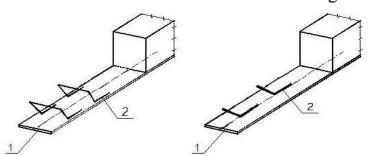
Die biegsamen Stahlbetonelemente mit der äußerlichen Blattbewehrung: 1 – das Stahlstützblatt; 2 – der Anker
